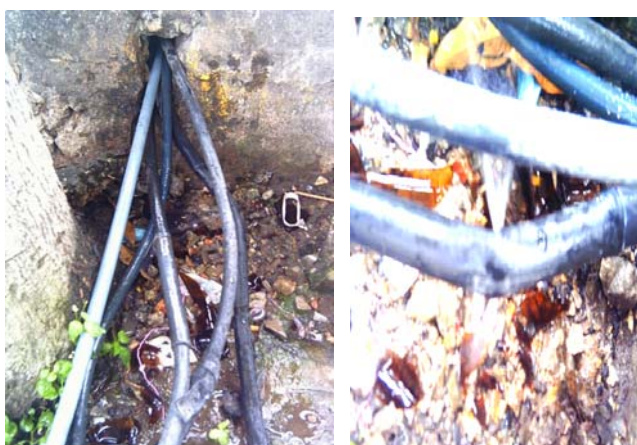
Conexiones ilegales en mal estado y rotura de tuberías PVC de $\frac{3}{4}$ ".
